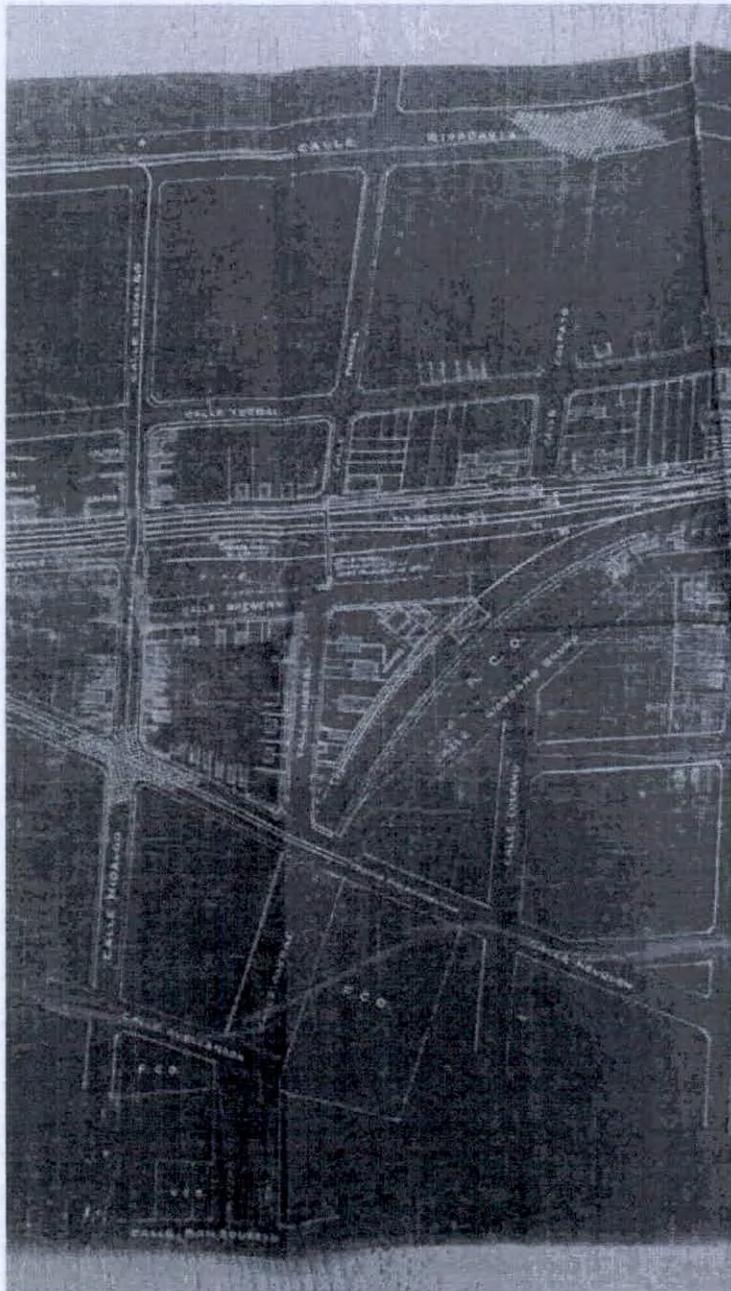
Plano PF Caballito de 1926 / sector 2
